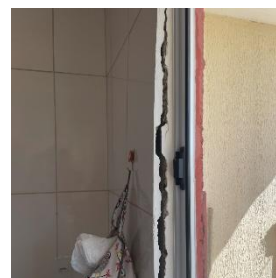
Parede com rachadura e azulejos descolando em Cornélio Procópio.
